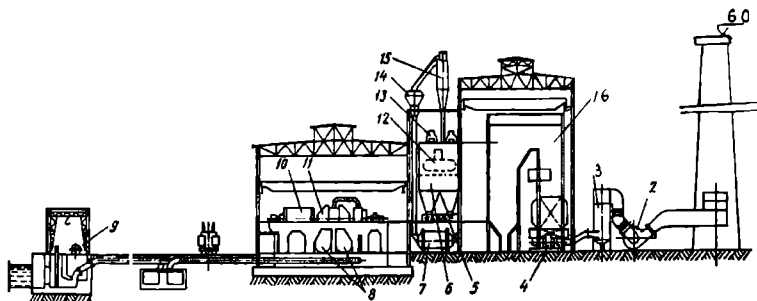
Поперечный разрез главного корпуса КЭС:
